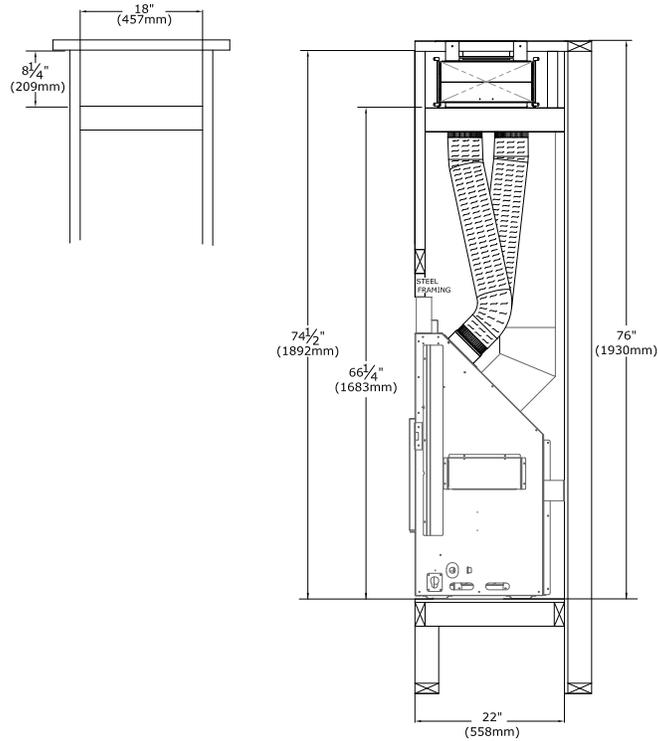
Dégagements et dimensions minimum d'encadrement de plénum pour le foyer Callaway 50
